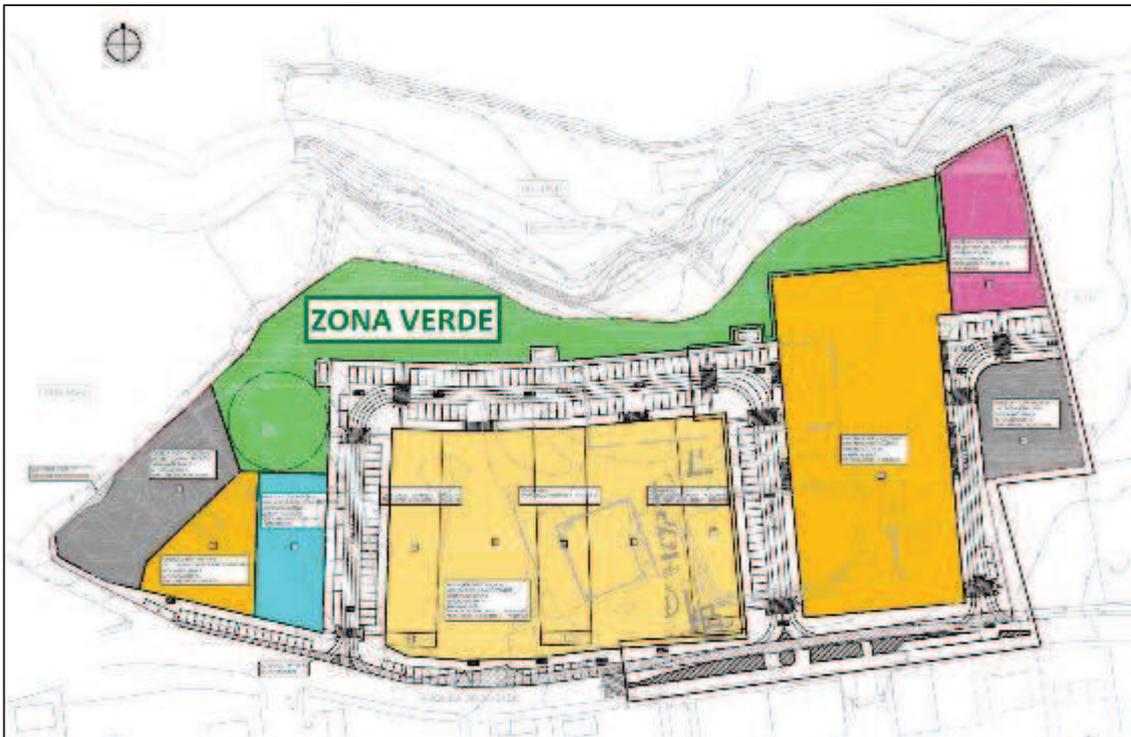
Detalle del Plano de Usos del Plan Parcial SU-NC_R4
